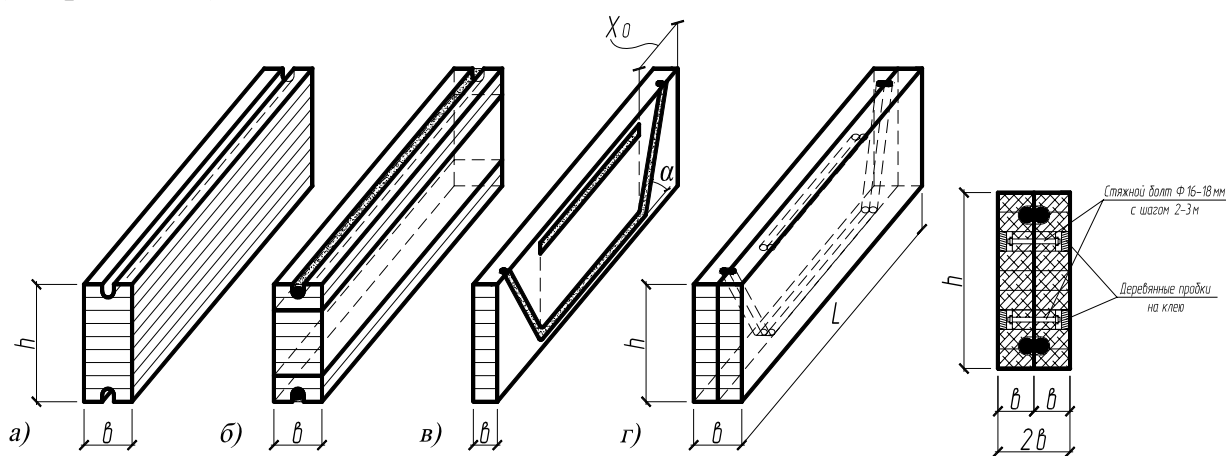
Технологические варианты изготовления деревянных армированных балок
